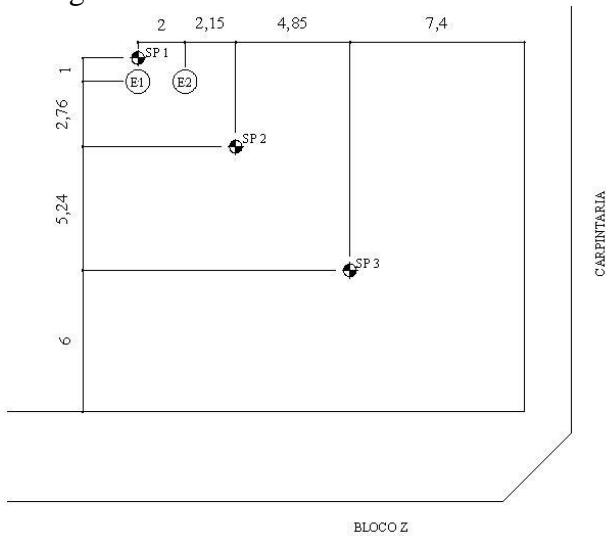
Planta de locação dos furos de sondagem e estacas submetidas à prova de carga estática.
